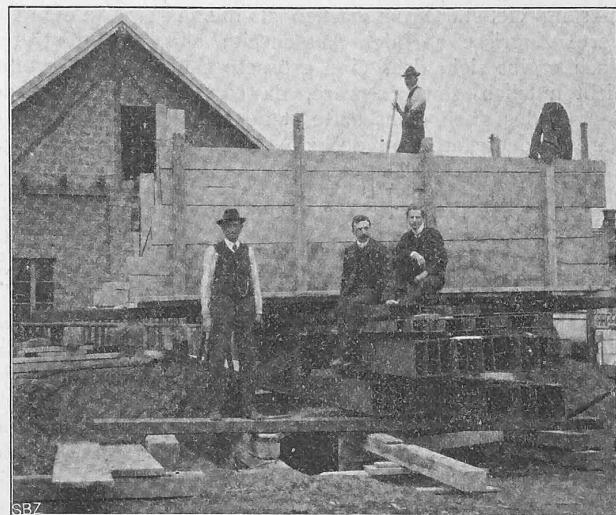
Einseitige Belastung mit Eisenbalken und Sandkiste.
